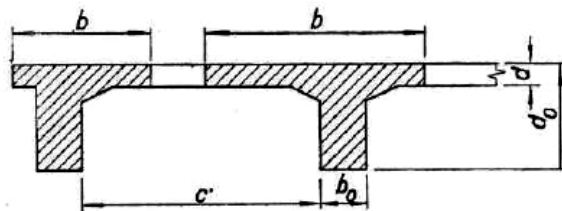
CASO 1 – Item 19 – Laje colaborante para vigas de seção T. (NB-1/1960)
